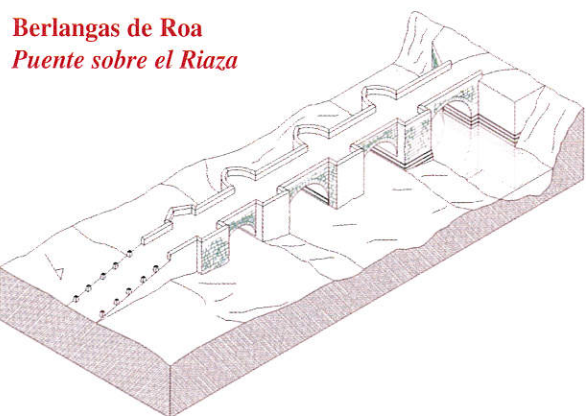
Axonometría del puente de Berlangas sobre el Riaza, son su primer estribo anguloso, procedente de un puente anterior.
